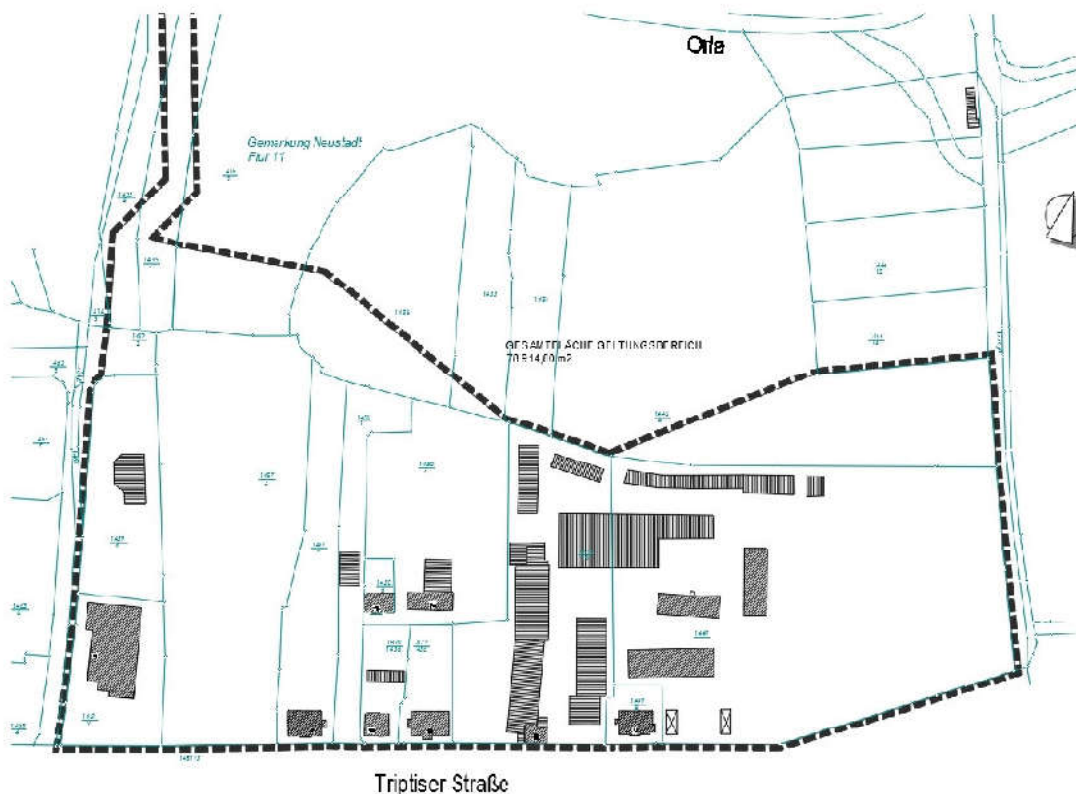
Lageplan mit Geltungsbereich, vorh. Bebauung und Flurstücken
